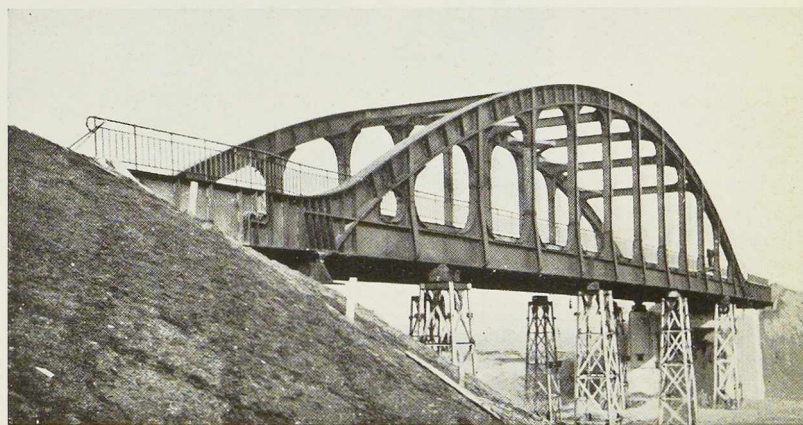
Vue générale du pont de Sutendael prise à la fin du montage.
